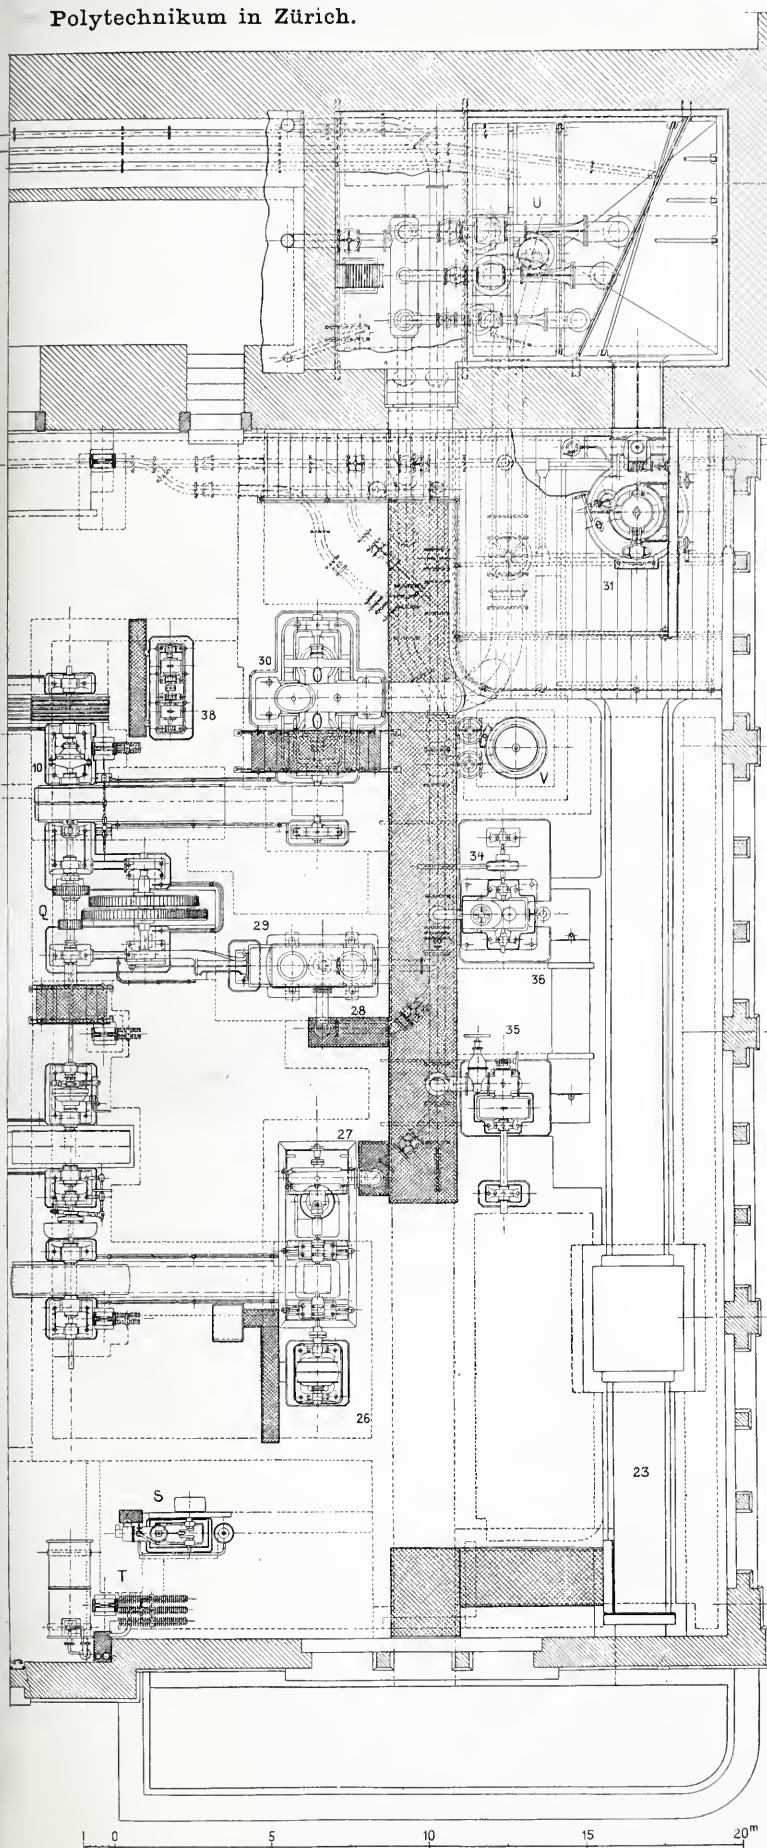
Grundriss der Maschinenhalle, südlicher Teil. 1:250.
